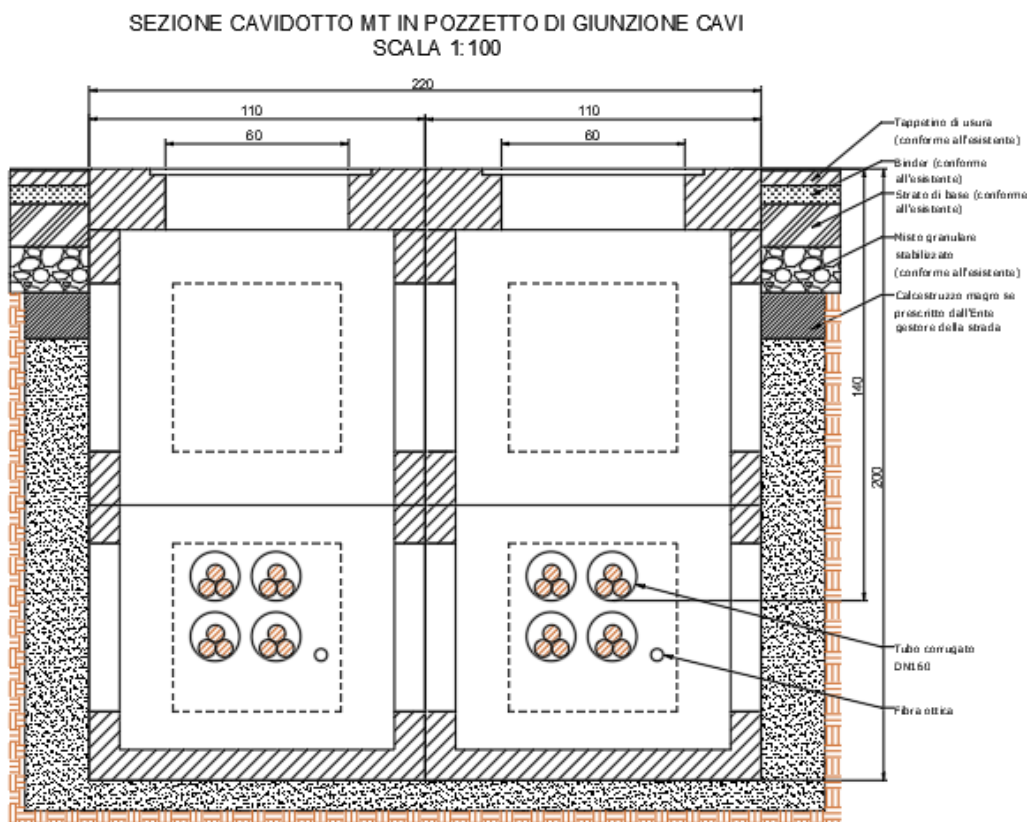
Tipologico sezione cavidotto MT in pozzetto di giunzione cavi
